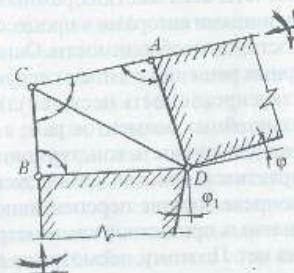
Расчетная схема карнизного узла рамы из досок с перекрестной стенкой на гвоздях
